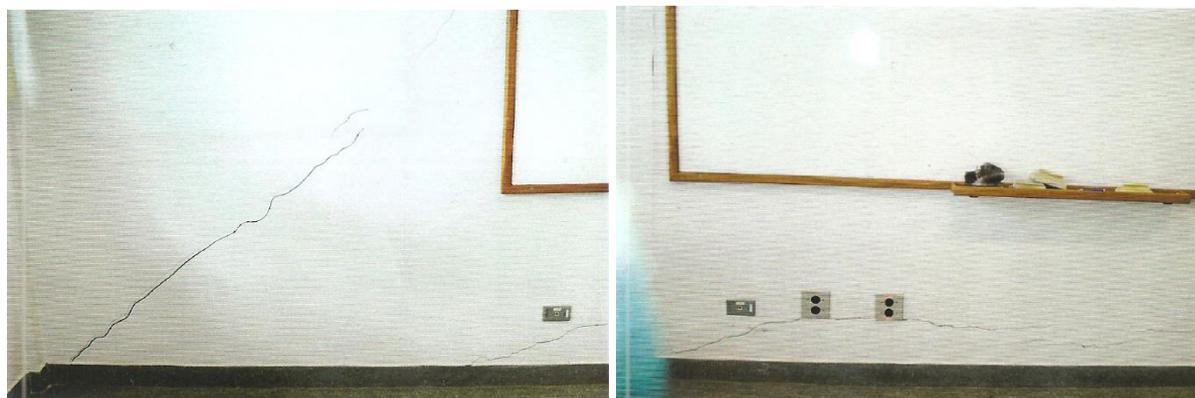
Configuração real de fissuras causadas pela deformação da estrutura de concreto (MENDES, 2007)
